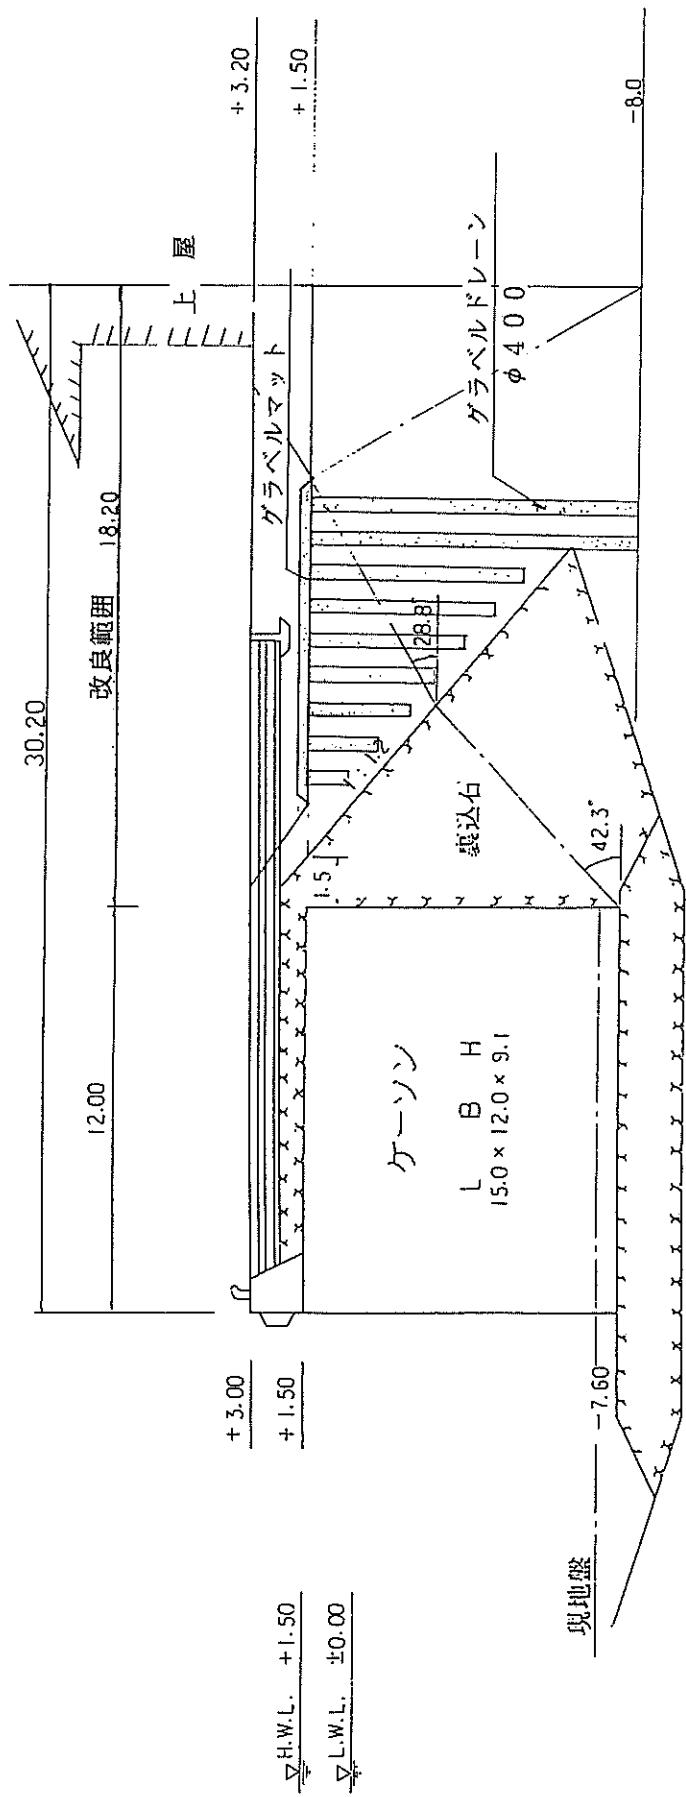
西港区第二埠頭地区②東側岸壁 (-7.5m) 浪状化対策断面図
